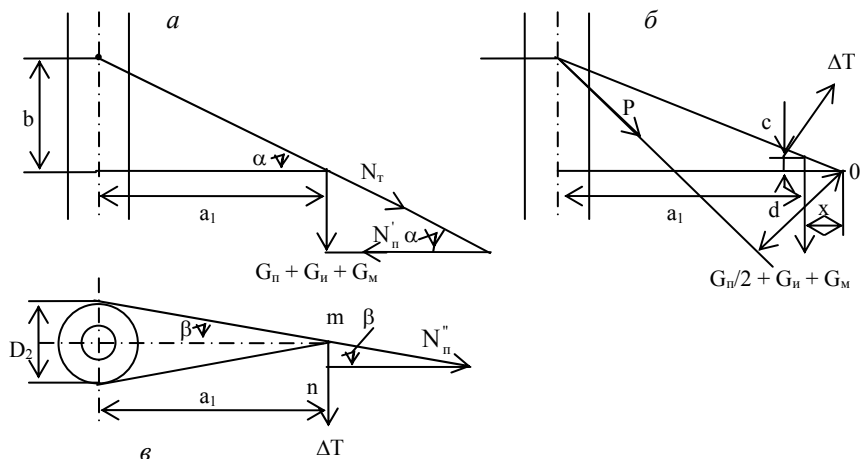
Расчетные схемы для определения усилий в поясах и тягах металлических траверс железобетонных опор:
